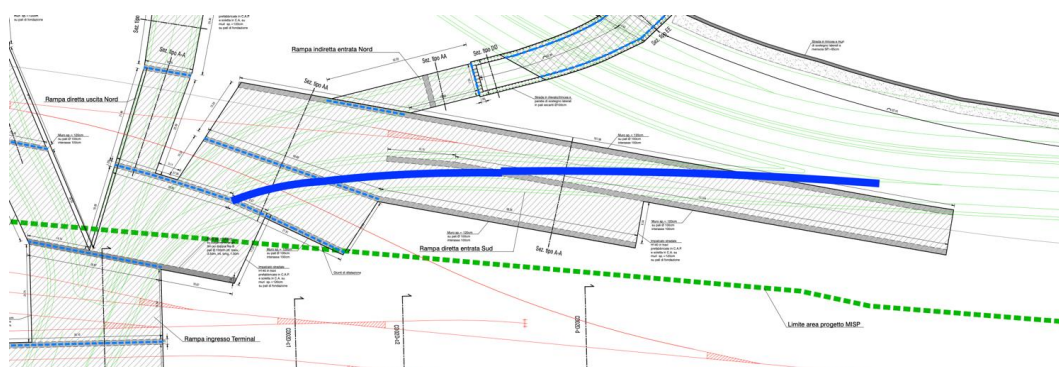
Planimetria con evidenziata la rampa diretta uscita Sud
